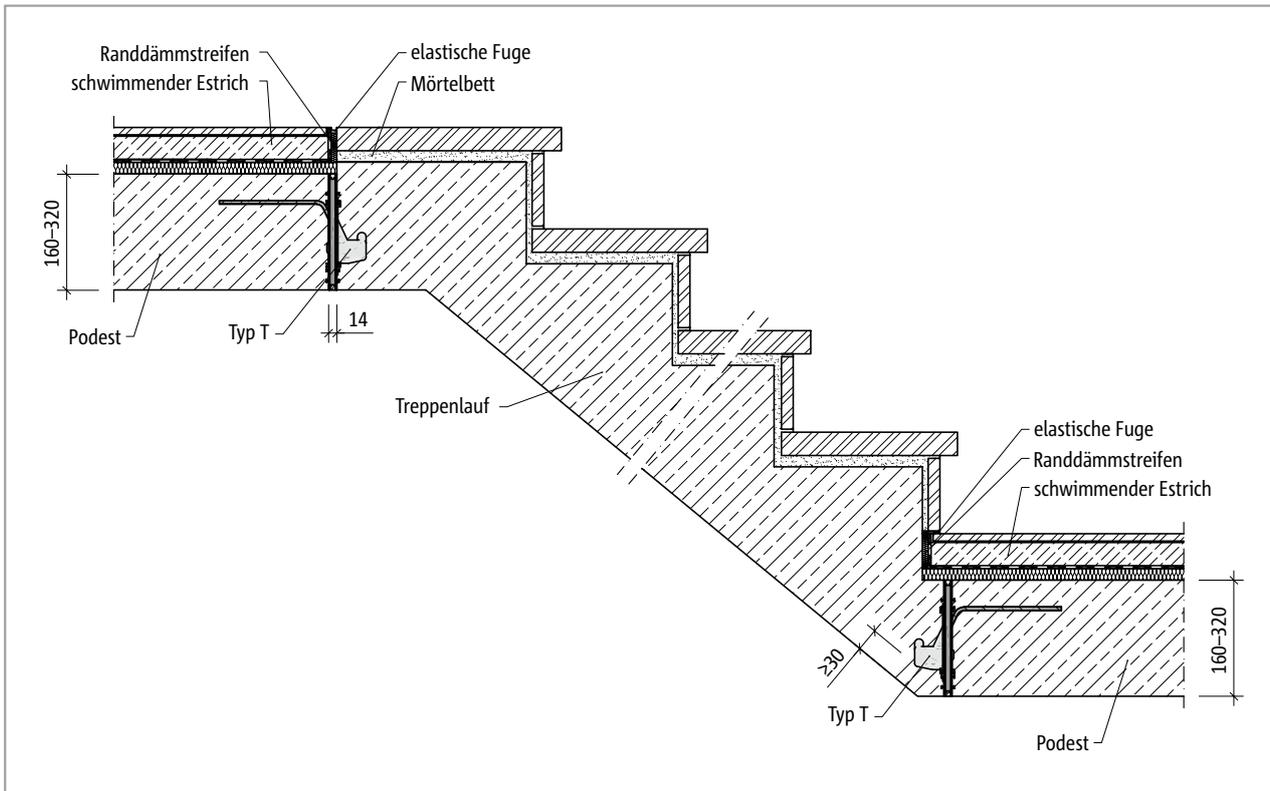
Schöck Tronsole® Typ T: Einbauschnitt
